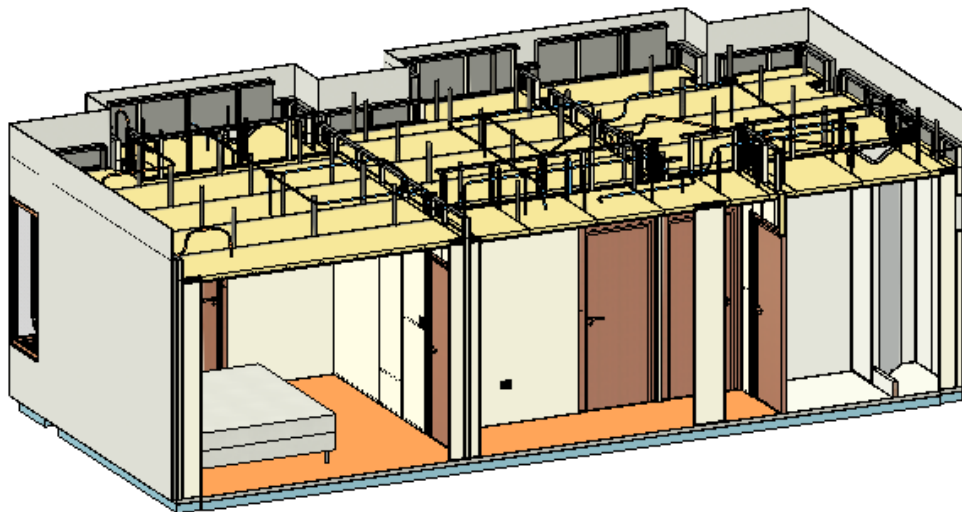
Modelo con elementos estructurales y arquitectónicos
